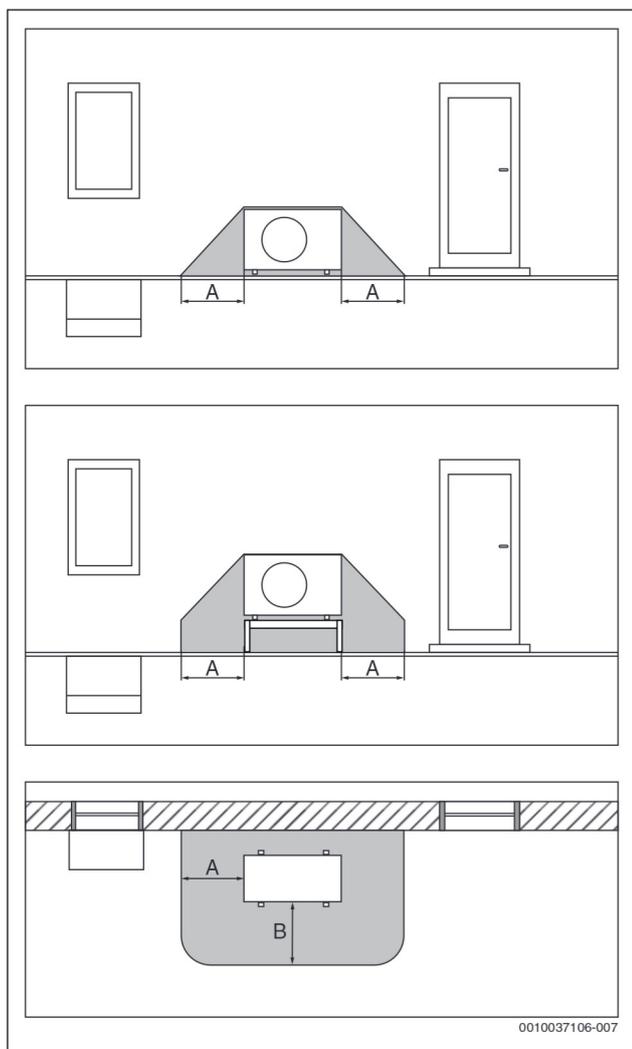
Schutzbereich, bodenstehende Wärmepumpe
